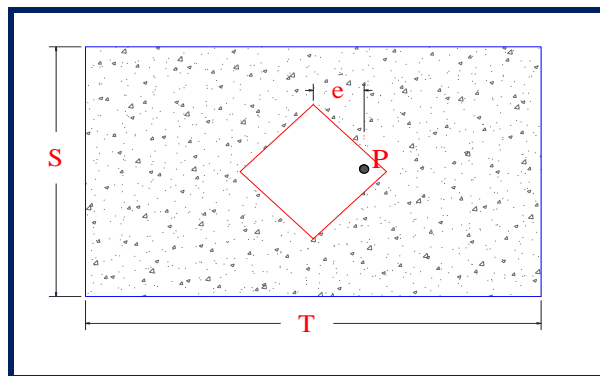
Modelamiento de zapata en elevación, de la carga P.
